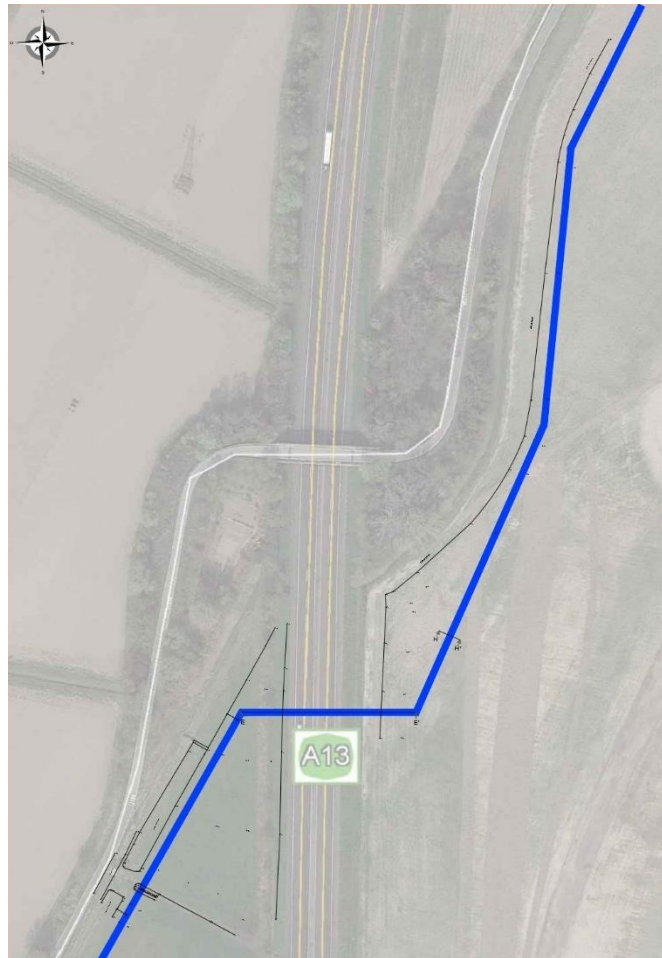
Tratto E-E' - Rilievo planoaltimetrico post-intervento
